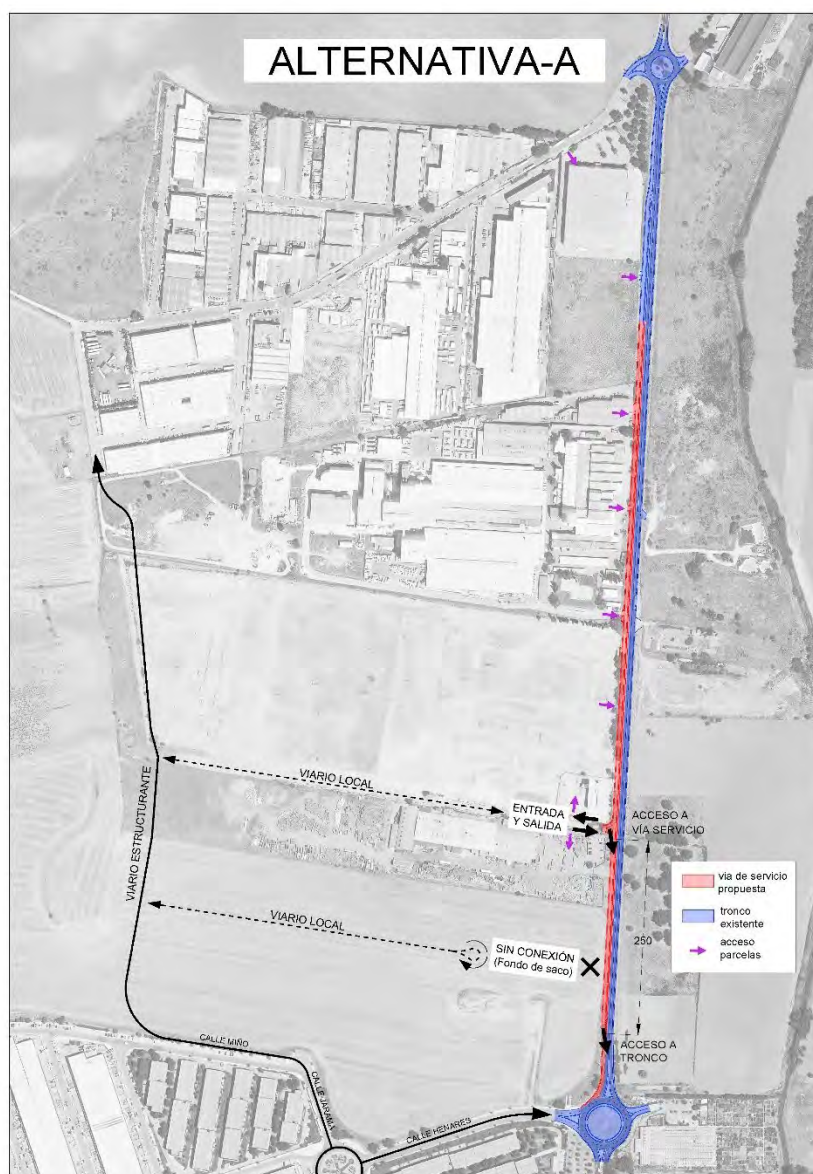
Plano alternativa A. Fuente Diaplan SAP.
